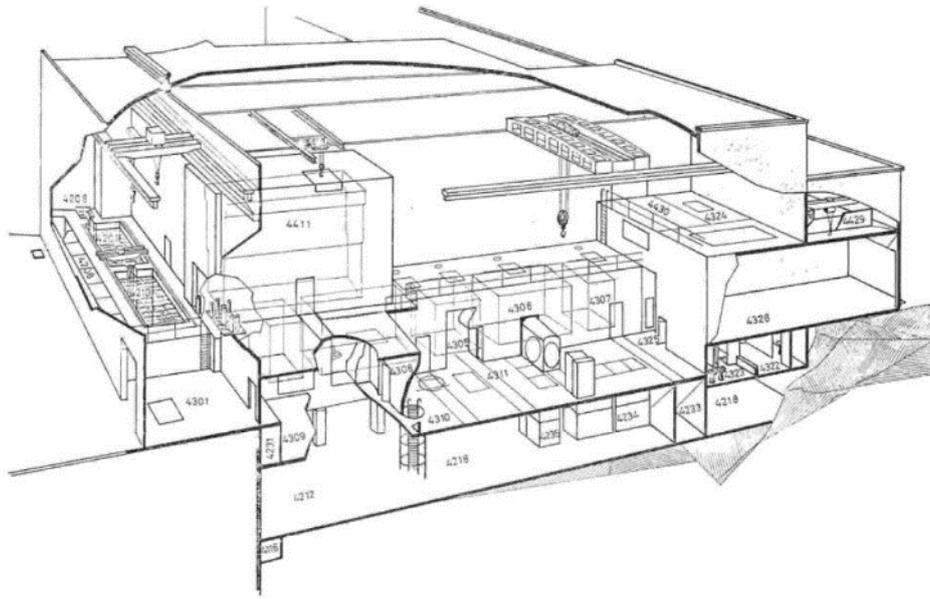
Prospetto laboratorio ADECO – Aree di lavoro
